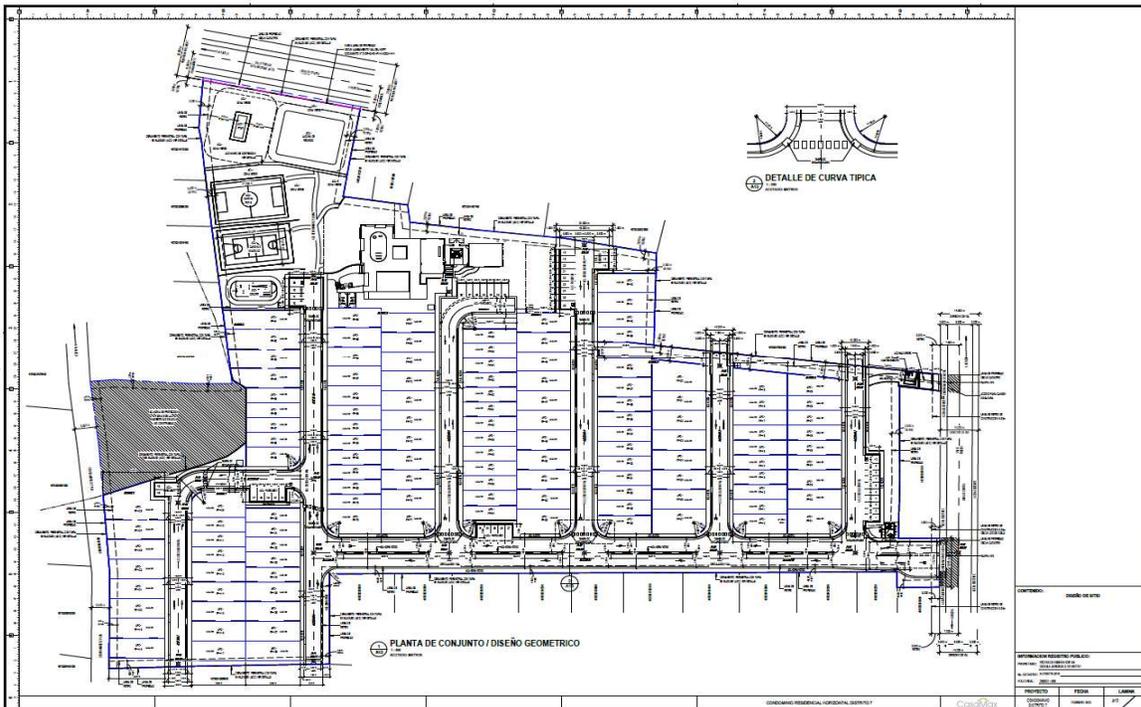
Diseño de Sitio, Imagen Ampliada, Fuente lámina constructiva # A-13. El proyecto constructivo integrado por un total de 125 Viviendas Unifamiliares distribuidos en dos casas modelos, cuyos detalles arquitectónicos se muestran a continuación:
